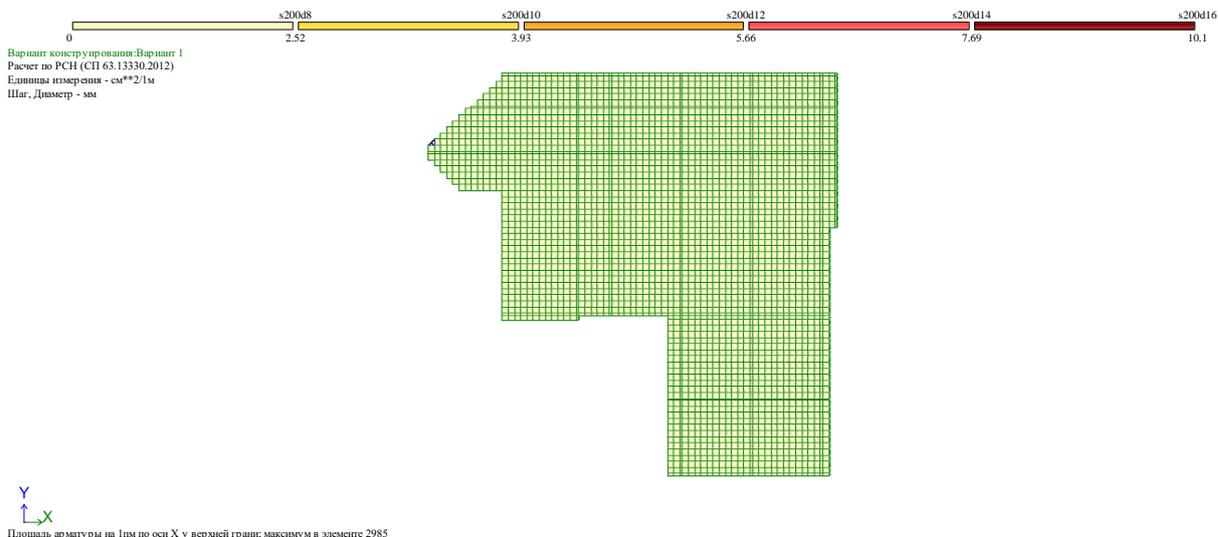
Подбор верхней продольной арматуры плиты по оси X
